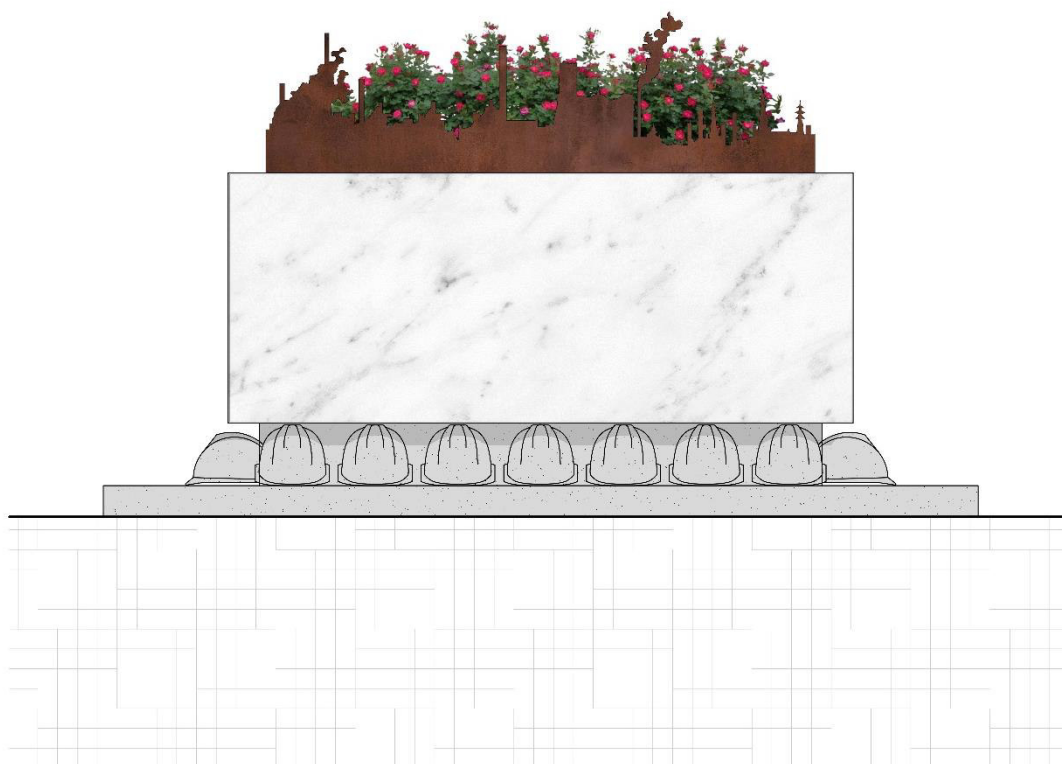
| Prospetto EST/OVEST - Stato di progetto
